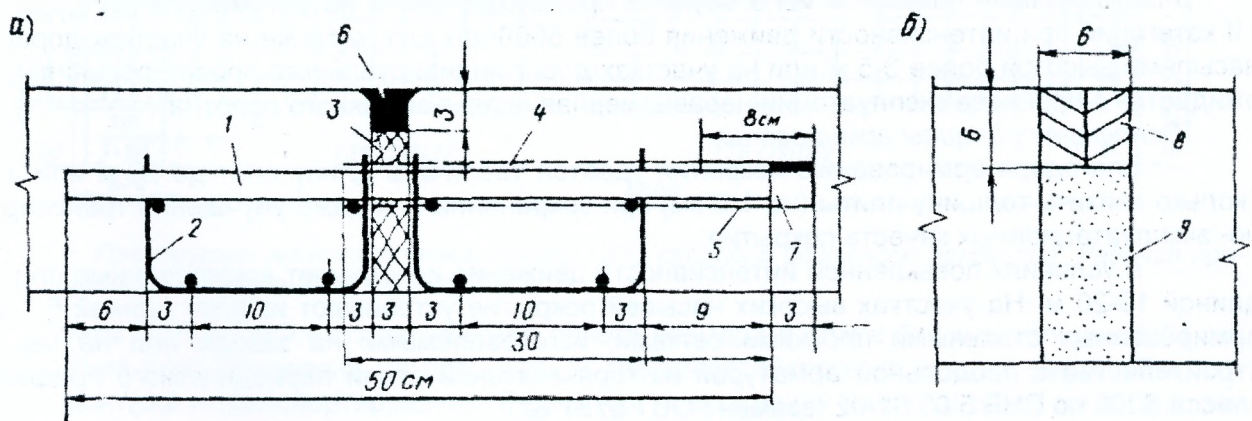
Типовые конструкции поперечных швов расширения: а – устраиваемые в покрытии; б – перед искусственными сооружениями; 1 – штыри; 2 – каркас-корзинка; 3 – деревянная доска-прокладка; 4 – битумная обмазка; 5 – колпачок из резины или полиэтилена; 6 – мастика; 7 – воздушный зазор в колпачке; 8 – герметизирующий материал или готовая резиновая прокладка; 9 – пористый легкосжимаемый материал
